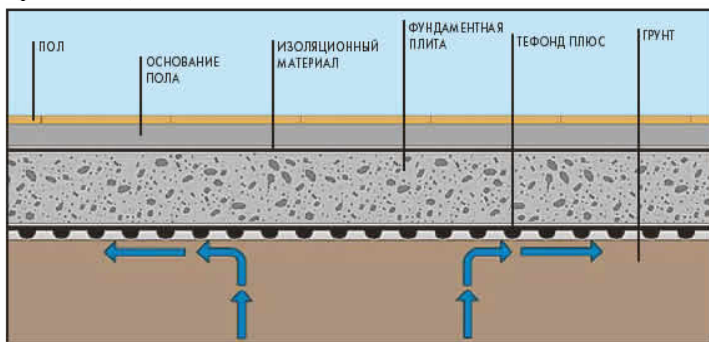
Дренажные каналы для отвода дождевой воды от основания фундамента
